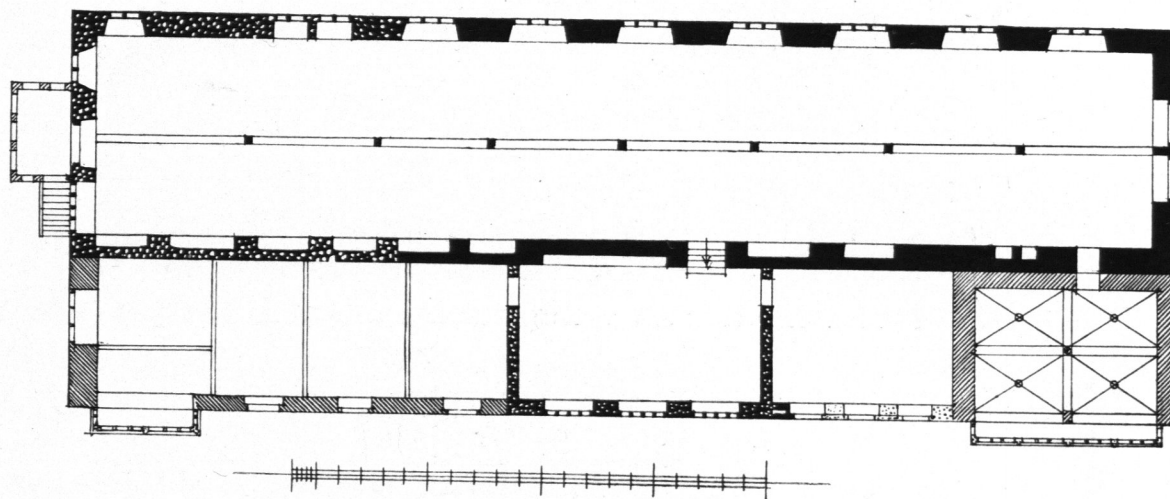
Rathaus zu Lemgo. Grundriß des Hauptgeschosses.
